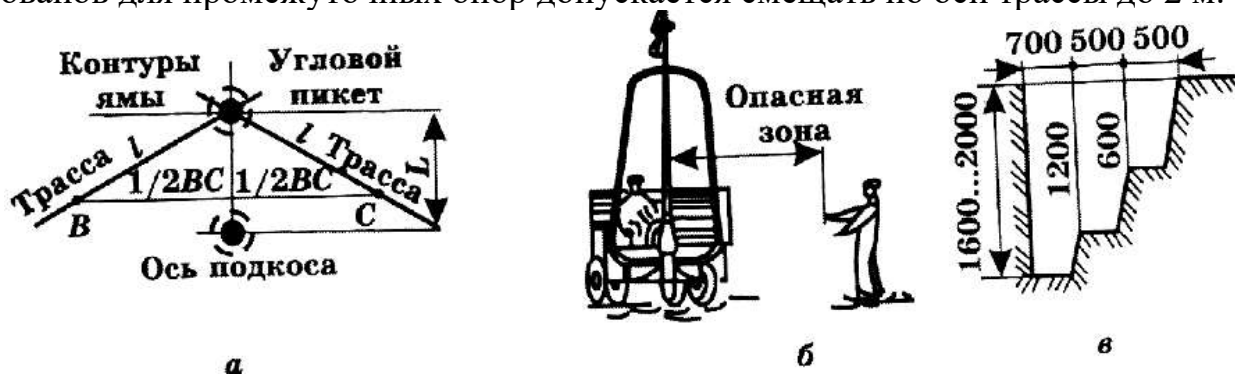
Рытье котлованов под опоры: а - разбивка центров котлованов для угловой опоры; б - Установка машины на пикет; в - размеры котлована для установки опор
